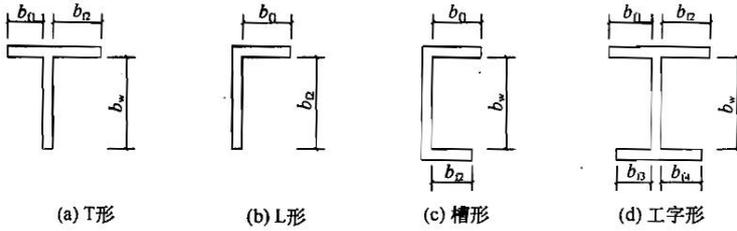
钢管束混凝土剪力墙腹板墙肢和翼缘墙肢的宽度示意
